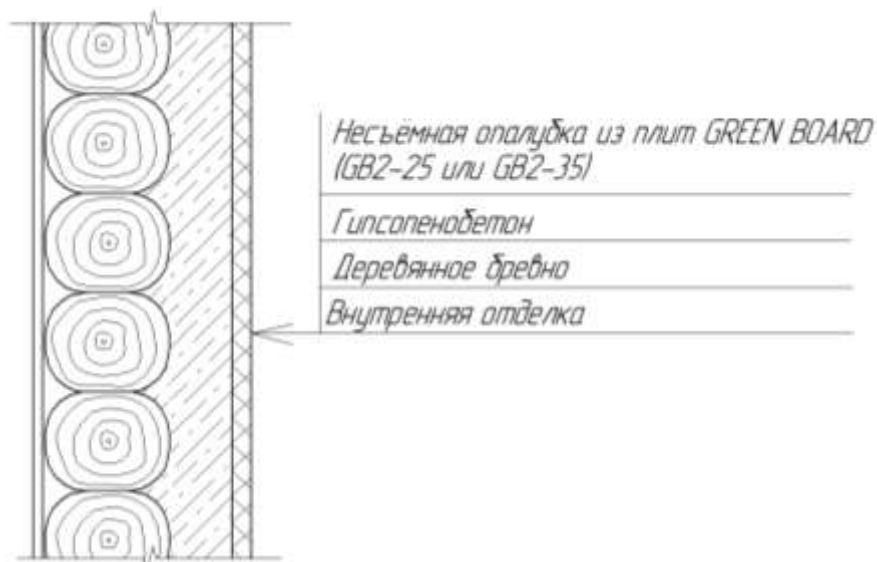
Разрез деревянной стены, восстановленной с помощью гипсопенобетона в несъёмной опалубке из плит GREEN BOARD®
